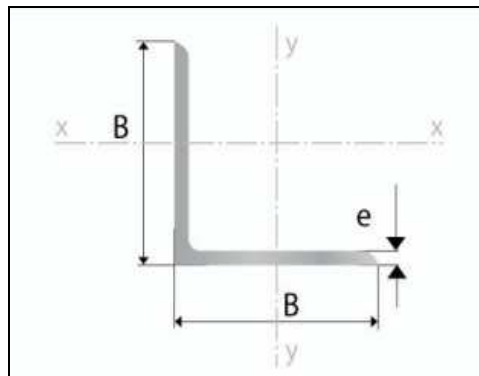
Sección Transversal Perfil Estructural (L 25x25x2)
